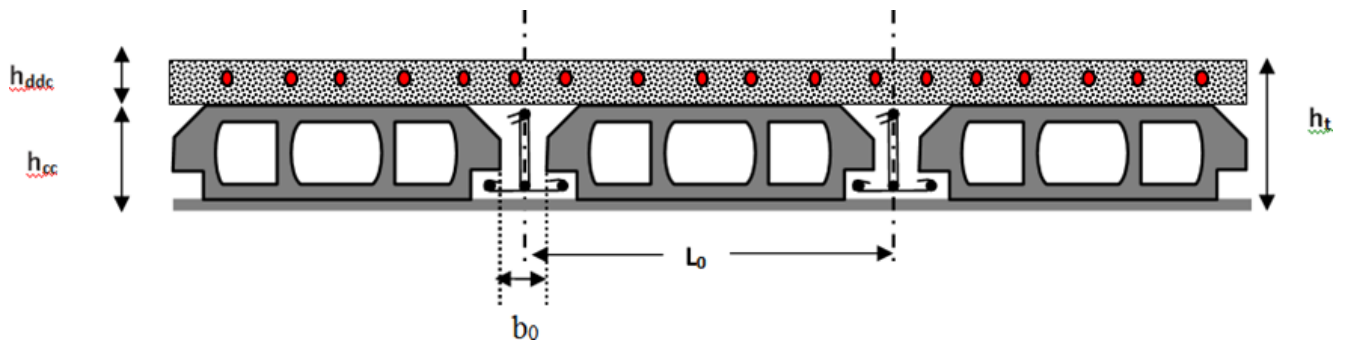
Coupe transversale sur un plancher à corps creux
